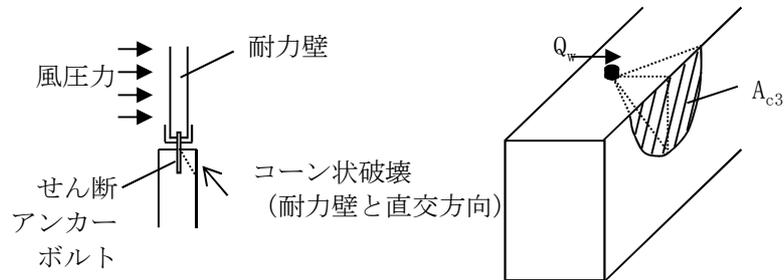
基礎側面のコーン状破壊 (耐力壁直交方向)
